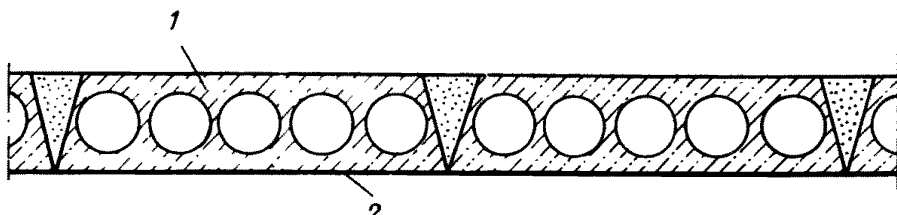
Усиление перекрытий из многопустотных настилов поверхностно-оклеочным стеклопластиком
